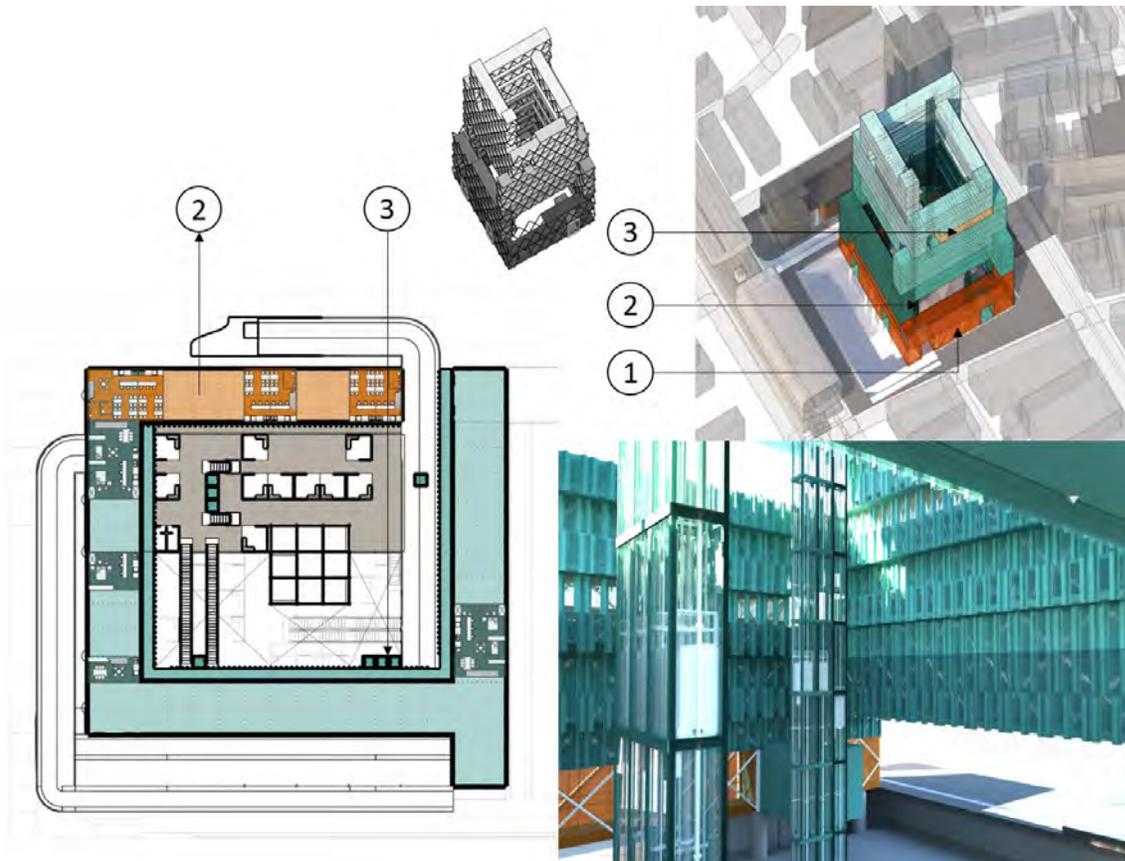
El Estrato vivienda. 1 corresponde a la planta baja comercial. 2 a los núcleos de circulación vertical. 3 a las zonas de vivienda productiva. En la parte superior hay un esquema del sistema estructural (Gris)
